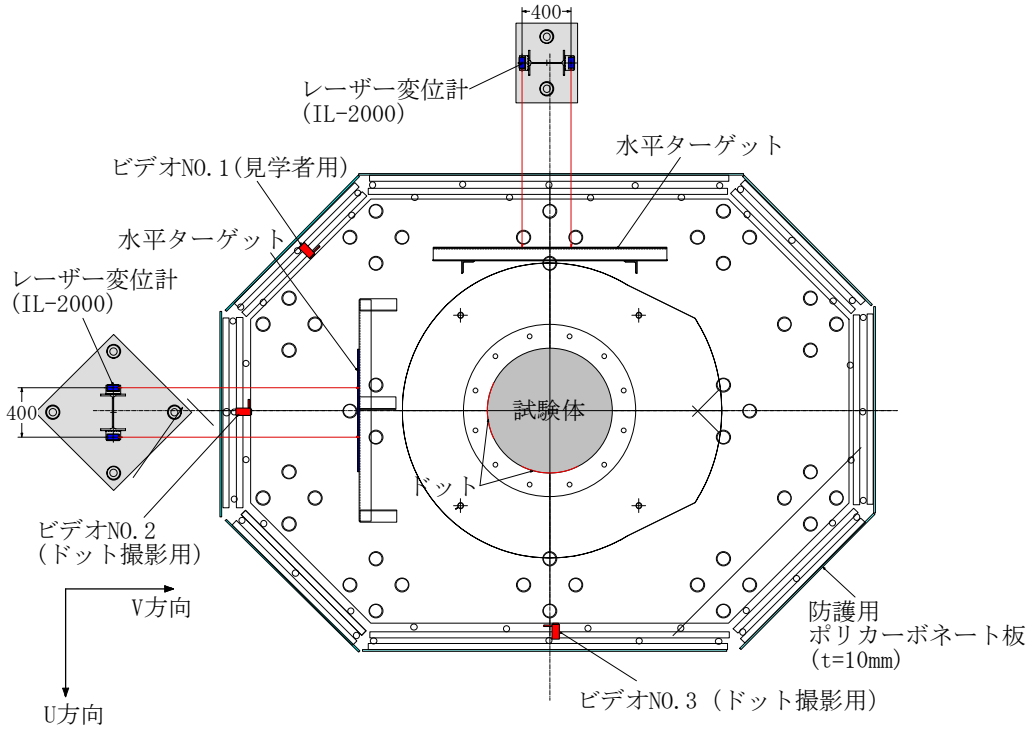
高減衰ゴム系積層ゴム試験体設置状況
